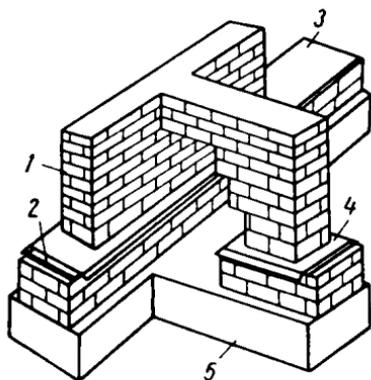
Схема расположения защитных щитков и примыкания внутренней стенки к наружной
